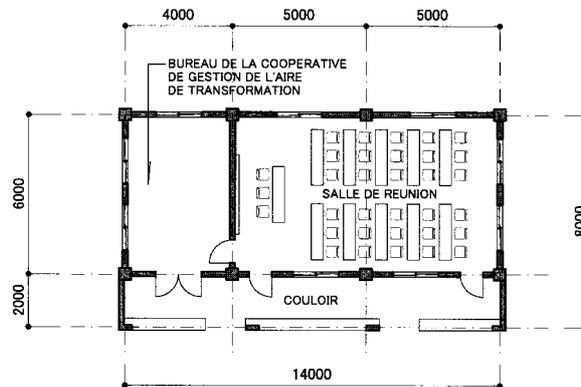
Plan planimétrique des locaux des installations de réunion des femmes transformatrices
